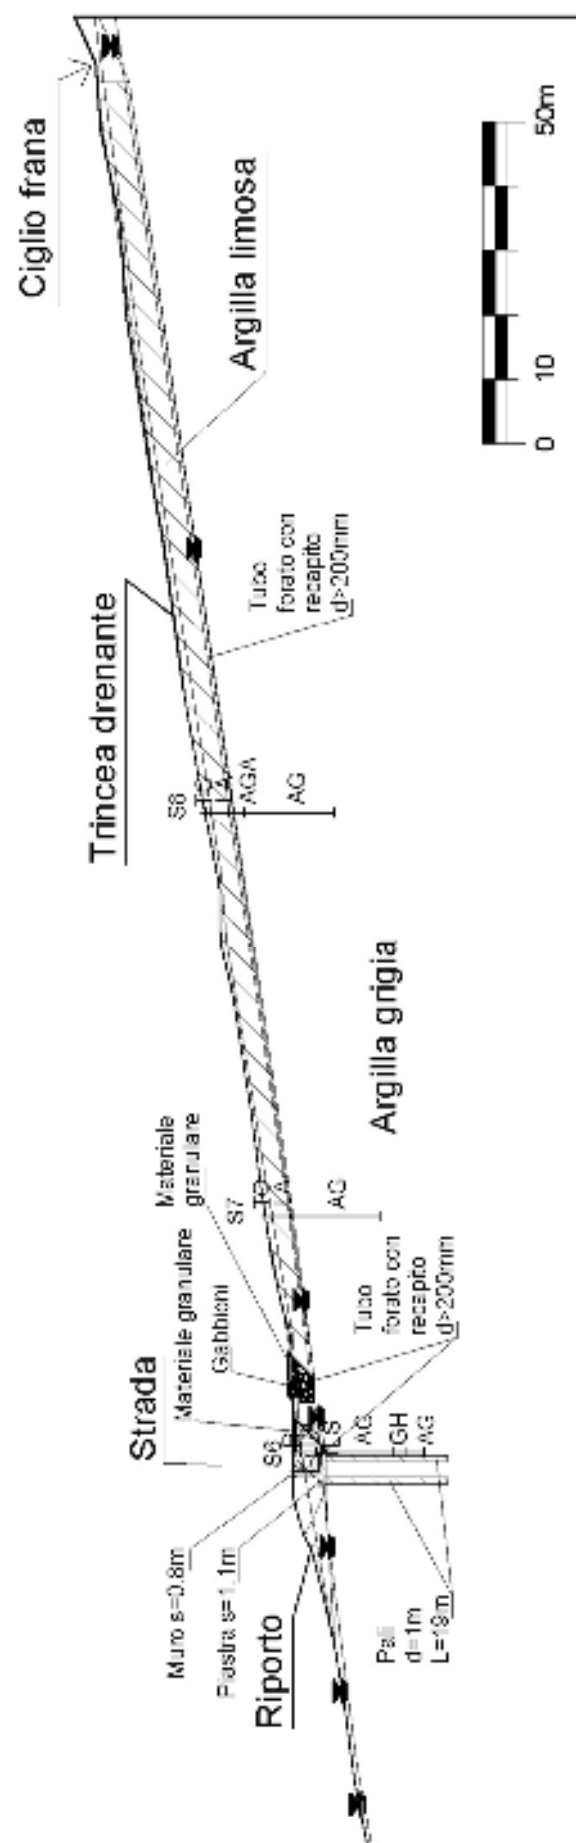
Dissesto al km 9+300. Sezione con schema degli interventi di consolidamento.
